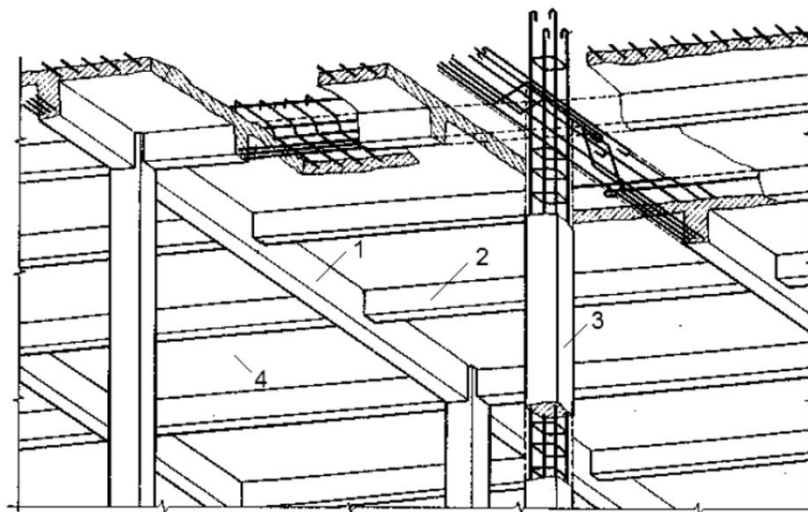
Монолитное ребристое перекрытие с балочными плитами: 1 - главные балки; 2 - второстепенные балки; 3 - колонны; 4 – плита
